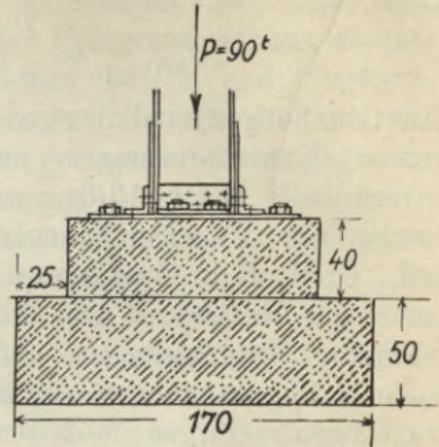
Grundmauererbreiterung in Betonmauerwerk.
